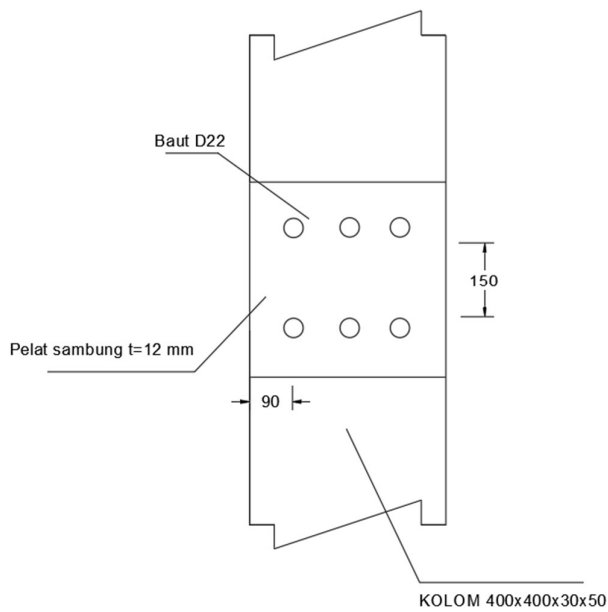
Denah Perletakan Sambungan Kolom-Kolom
